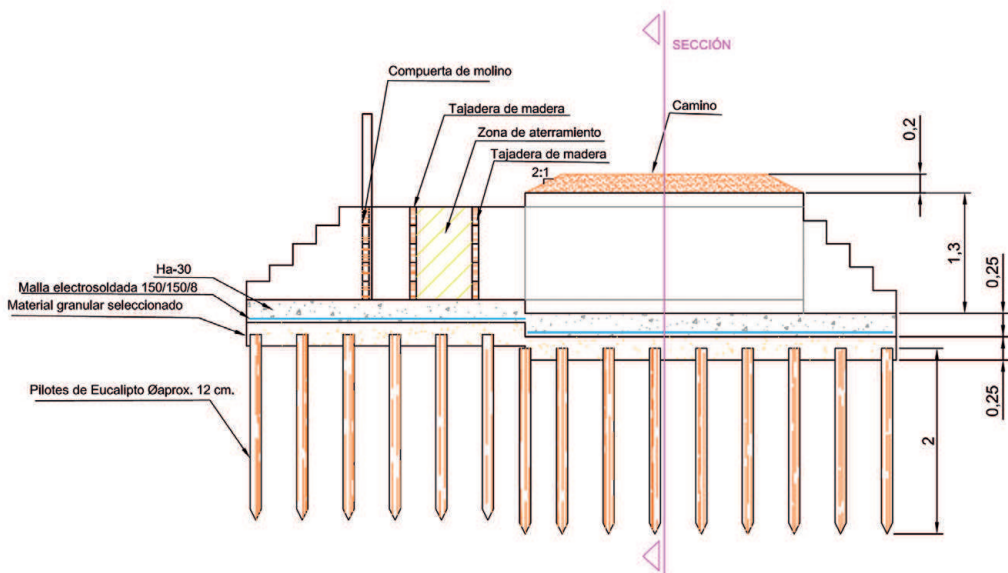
Detalle de sección del la compuerta de madera a su paso por el muro. Fuente: Demarcación General de Costas.
